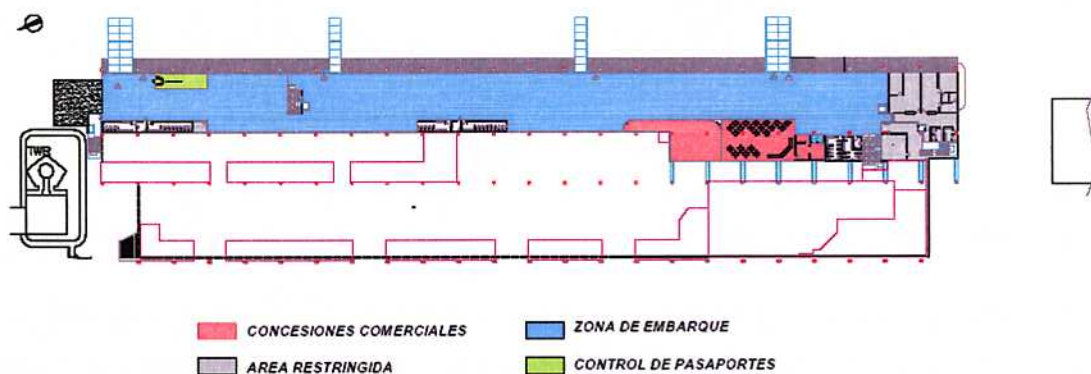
Ampliación Edificio Terminal. Planta baja
